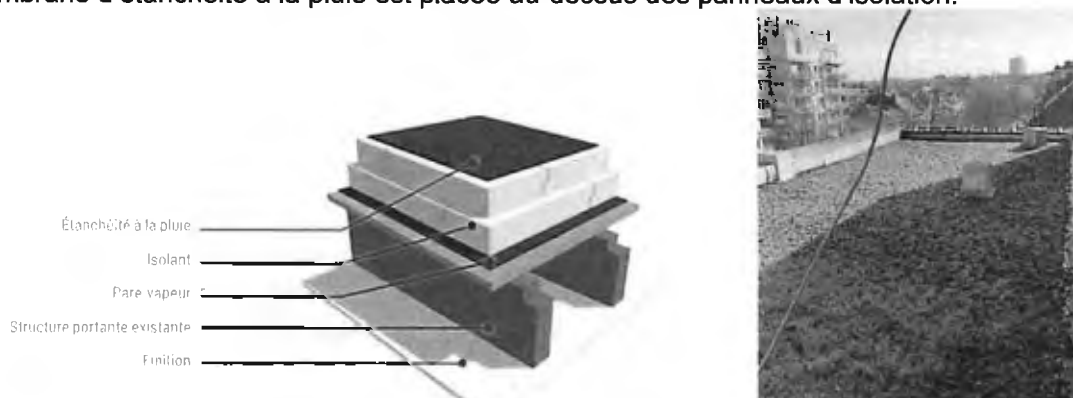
Principe d'isolation par l'extérieur (gauche), toiture (droite)
